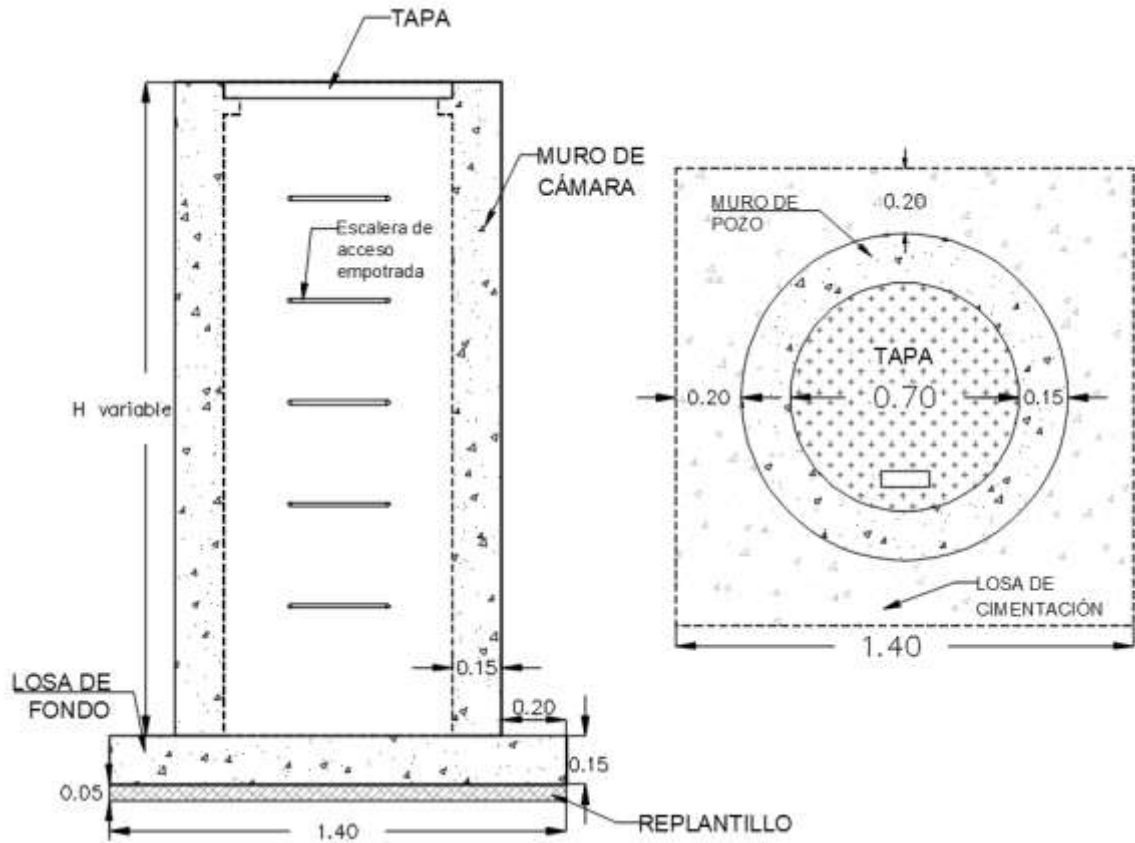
12 Cámara de Inspección Alcantarillado Sanitario
